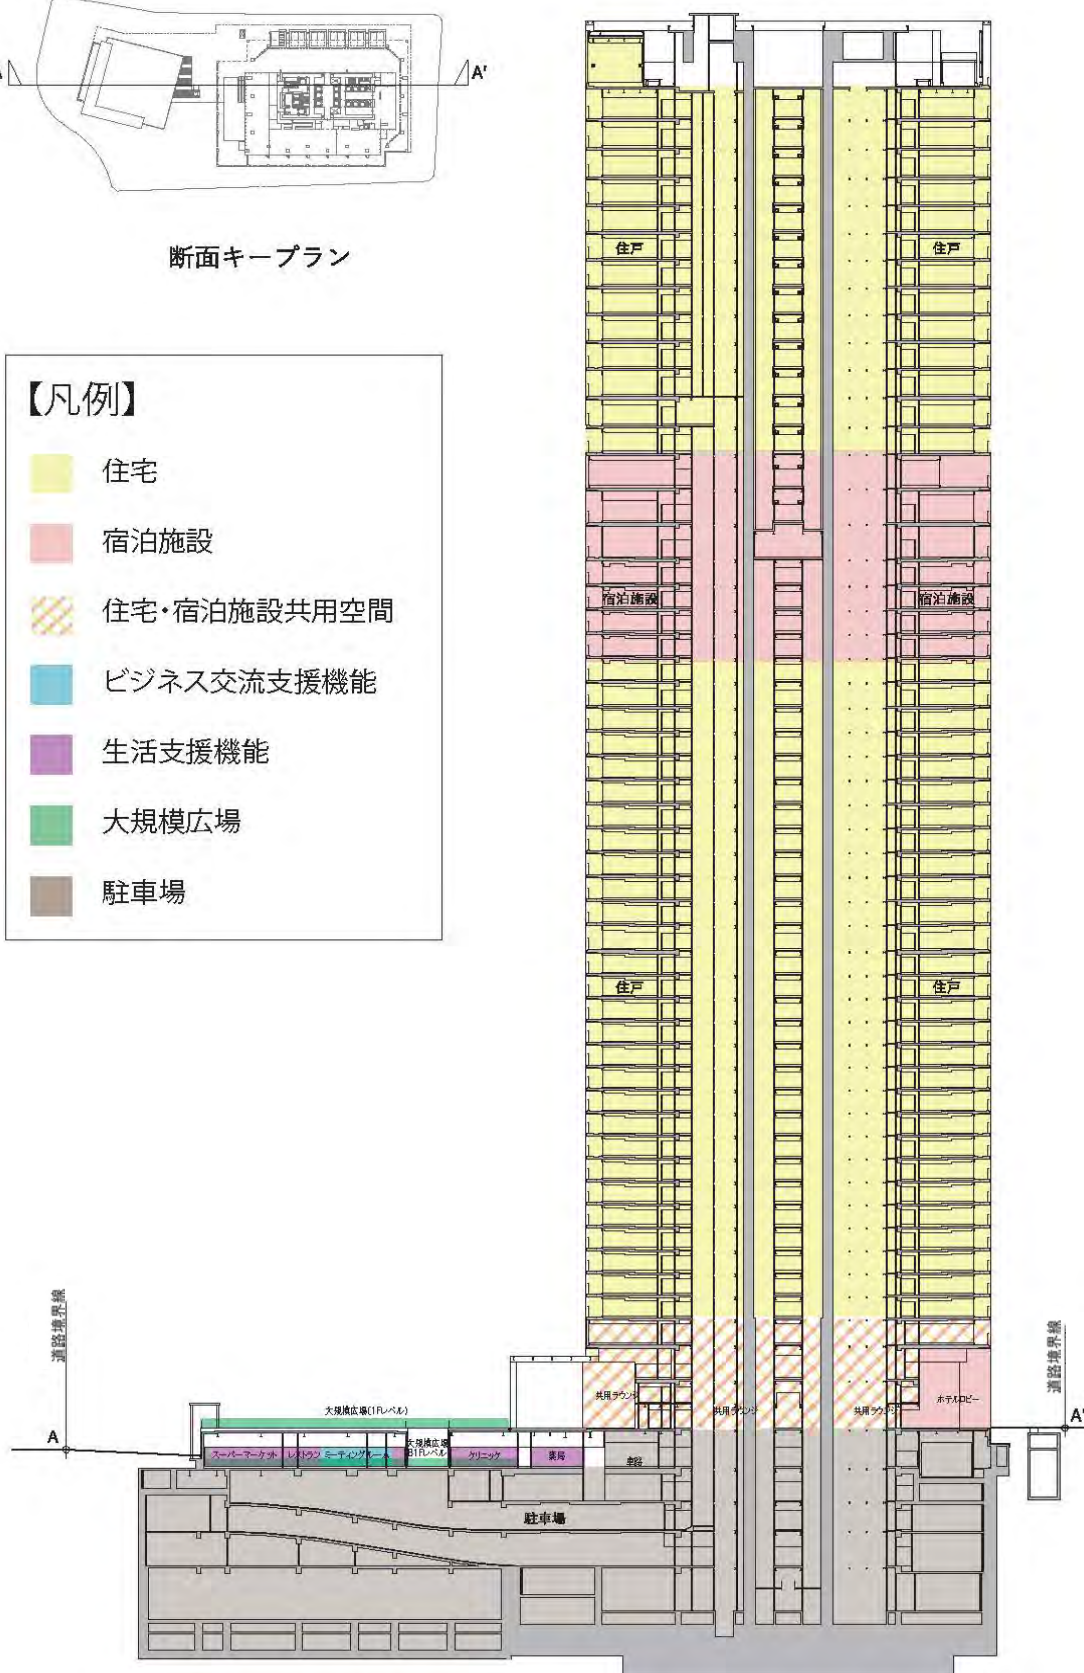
(1) 断面図 (A-A'断面 S=1:1, 200) 【変更前】
